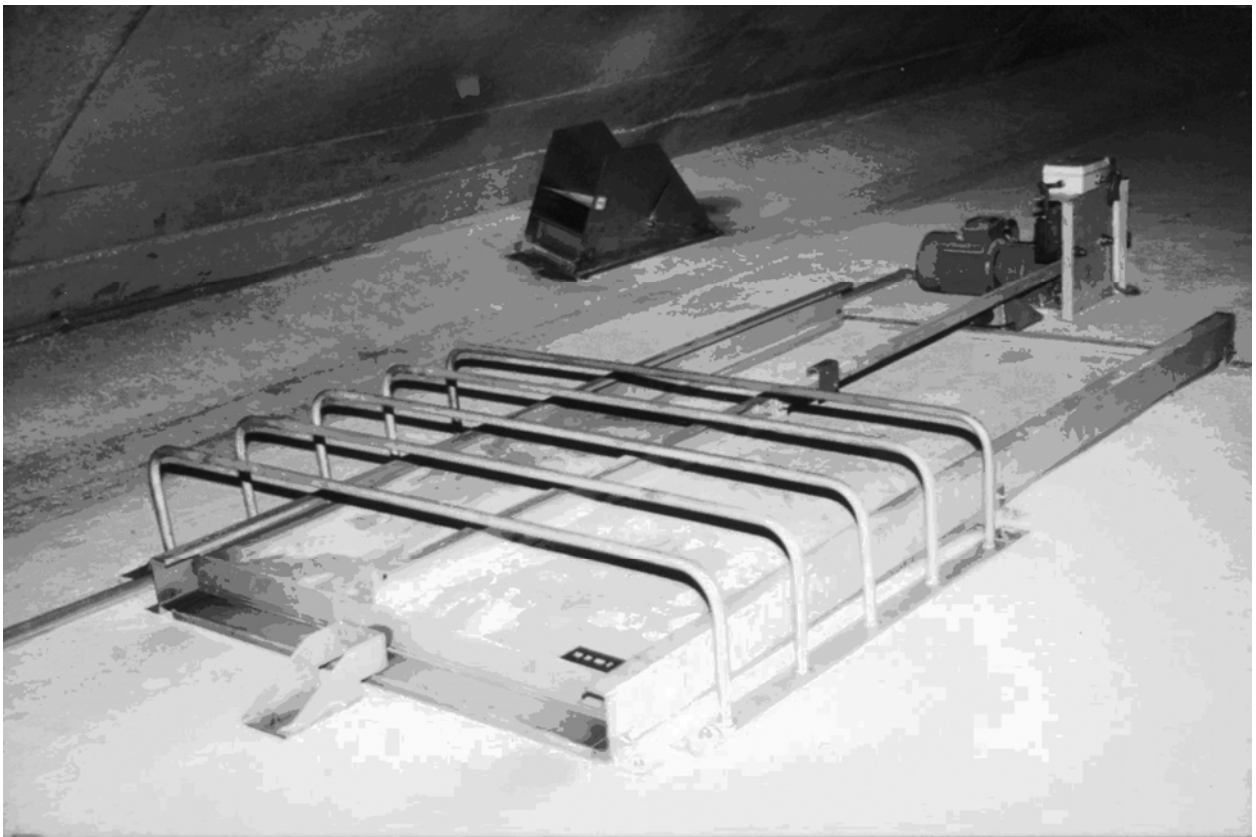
Installation d'une trappe d'extraction à lames parallèles / Parallel bladed smoke damper installation
